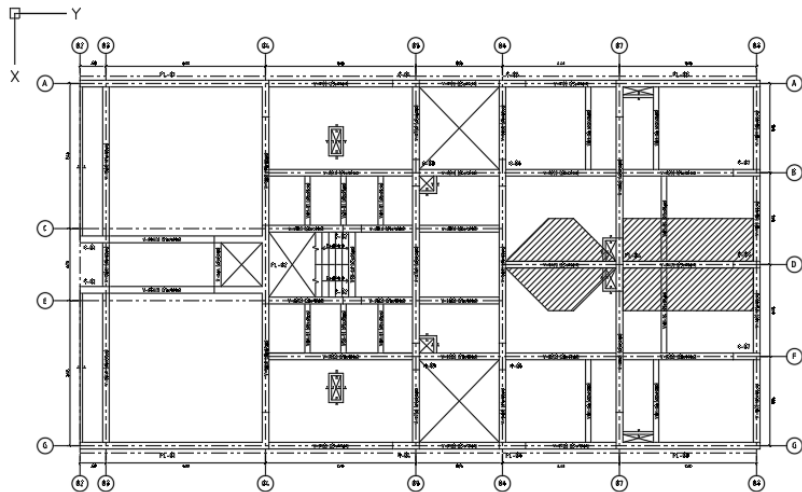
Área tributaria de la viga V-04(2) en la planta del edificio.
